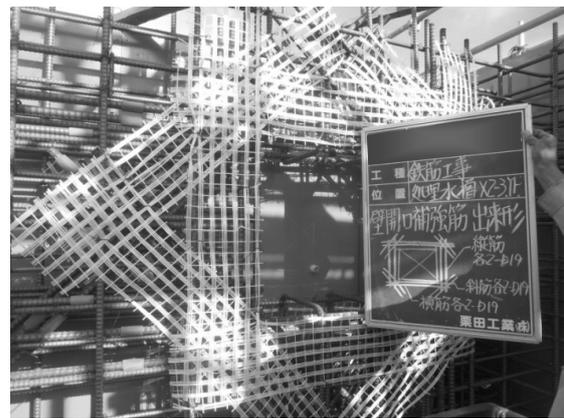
開口部へのガラス繊維ネット設置と躯体状況
